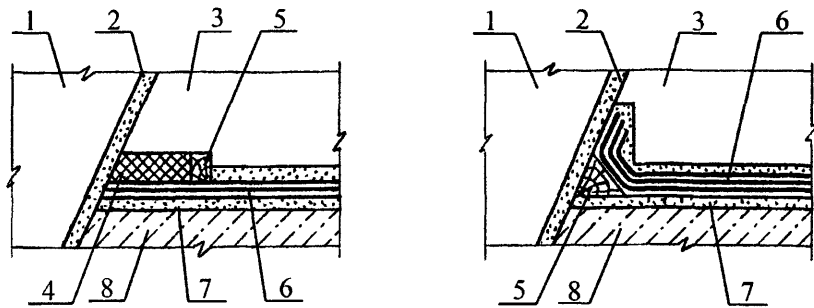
Сопряжение оклеечной гидроизоляции дна опускного колодца с цементной гидроизоляцией стен
